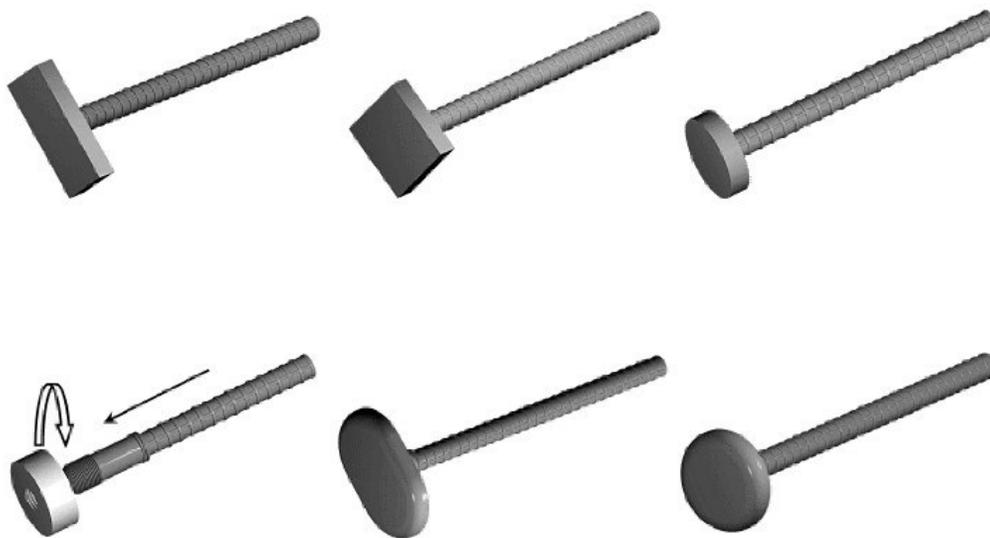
Exemplos de dispositivos para ancoragem mecânicas das barras das armaduras.
